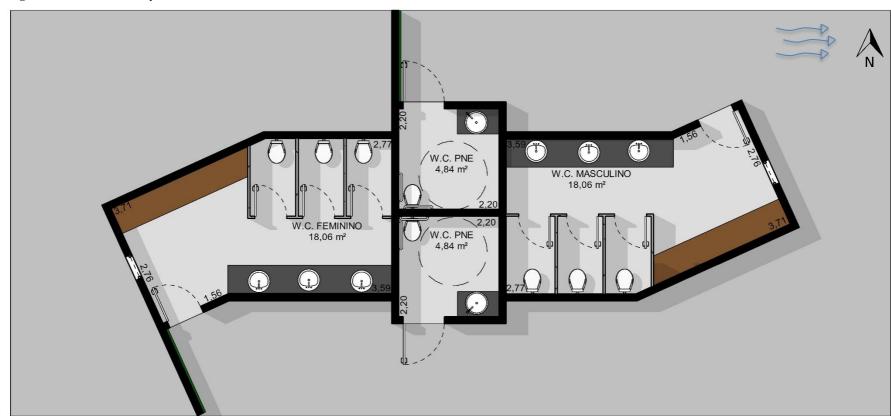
Planta de Layout humanizada Bloco de sanitários.
